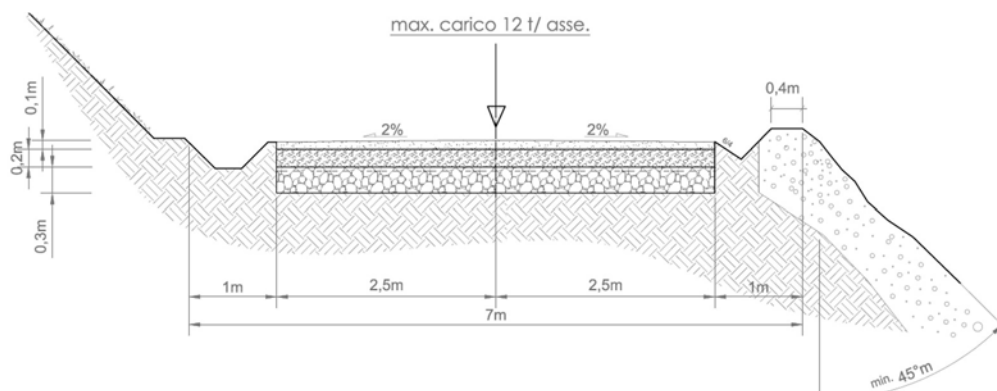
Sezione stradale tipo con scarpata (mezza costa)
